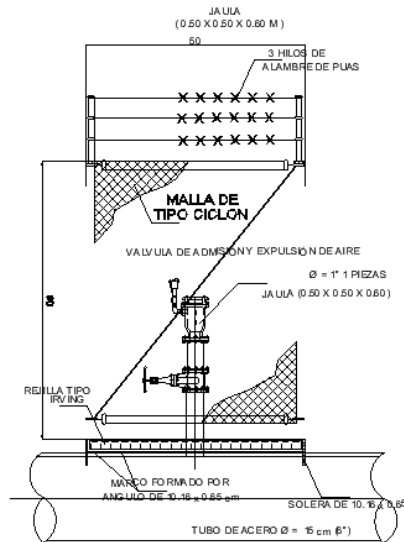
Detalle de colocación de tubería de acero negro sobre arroyo.
